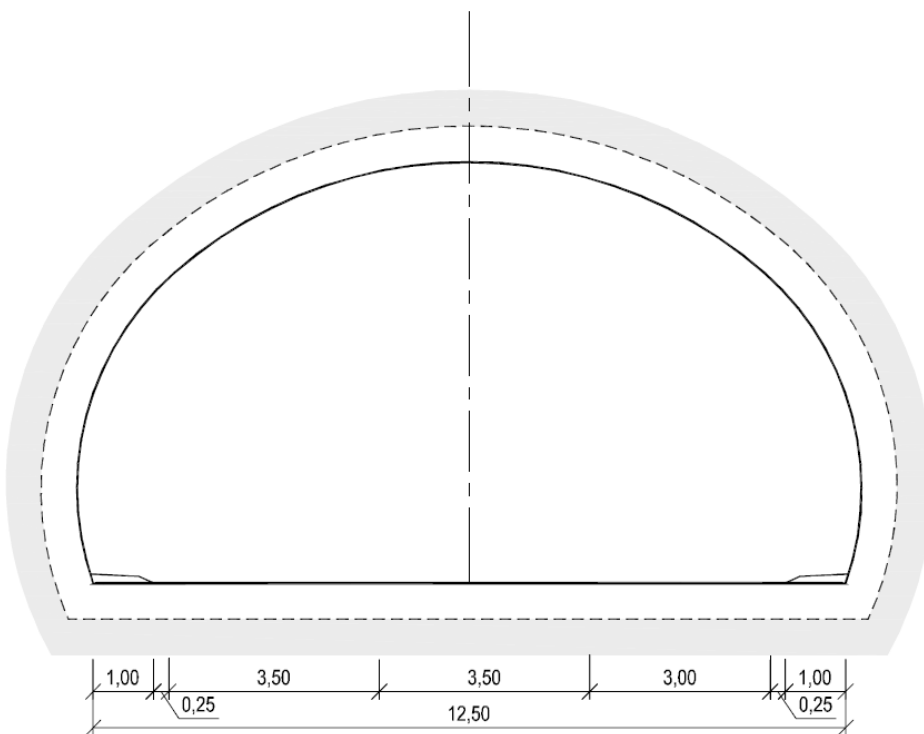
Tunnelprofil T11,5 (mål i m).
